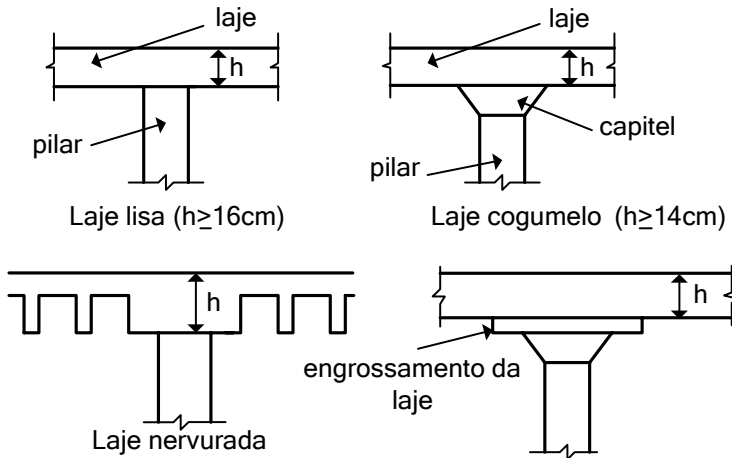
Lajes lisas e lajes cogumelo
